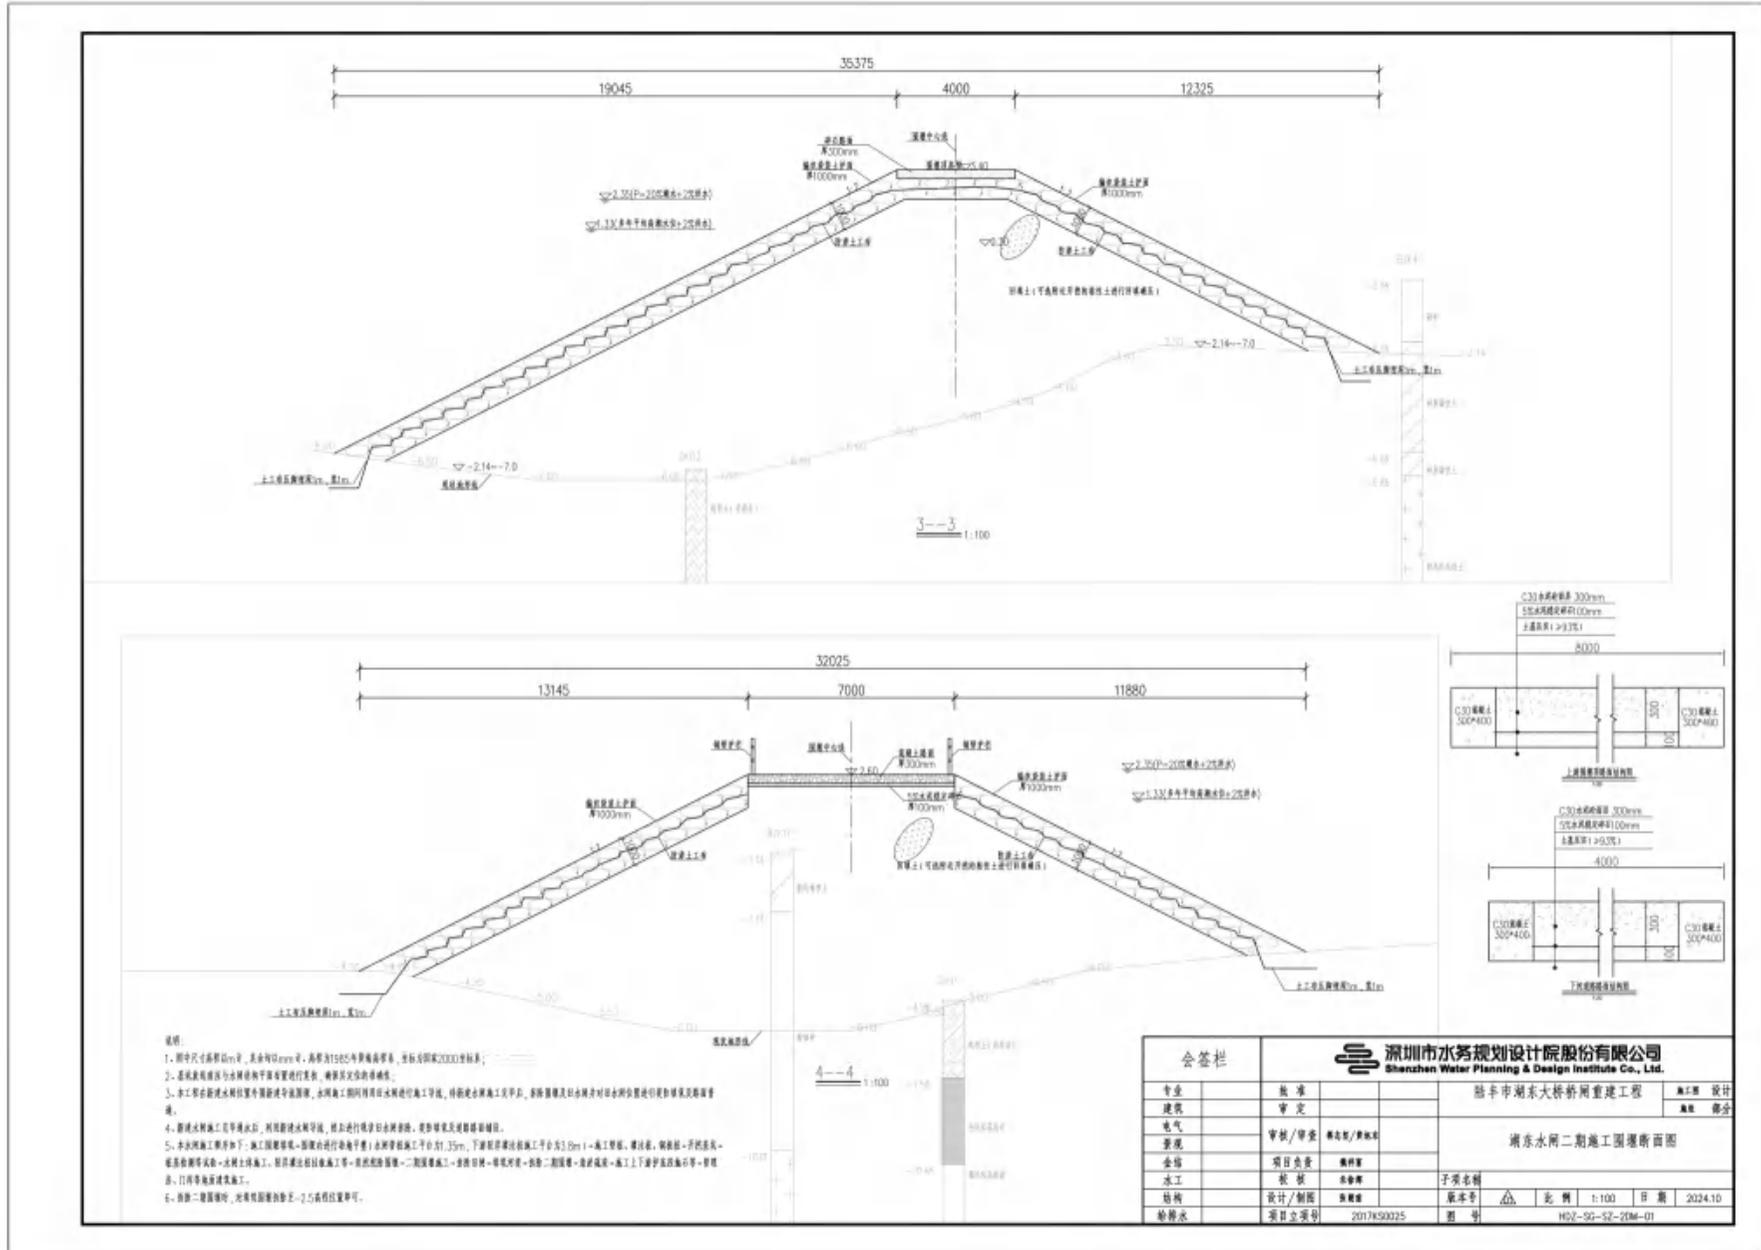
湖东桥闸二期施工围堰断面图
